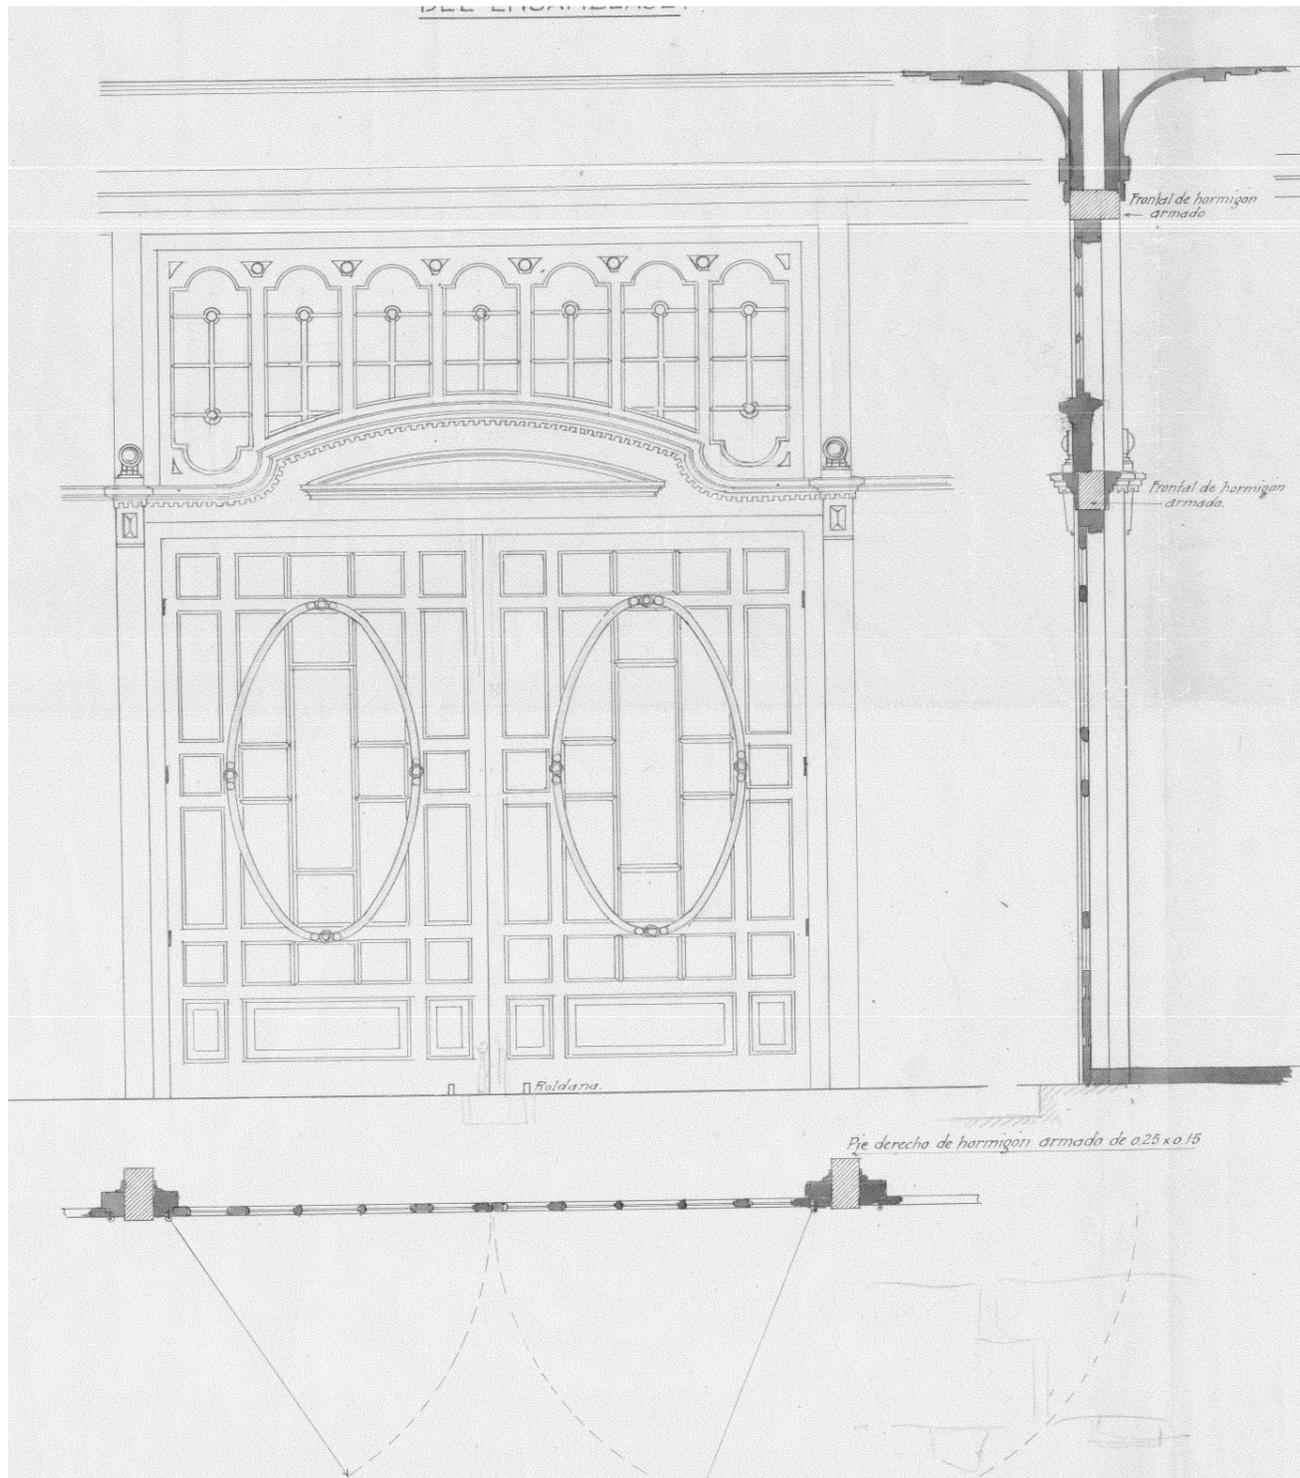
Detalle de las carpinterías del salón, Archivo Municipal de Bilbao, Fondo Ricardo Bastida.
